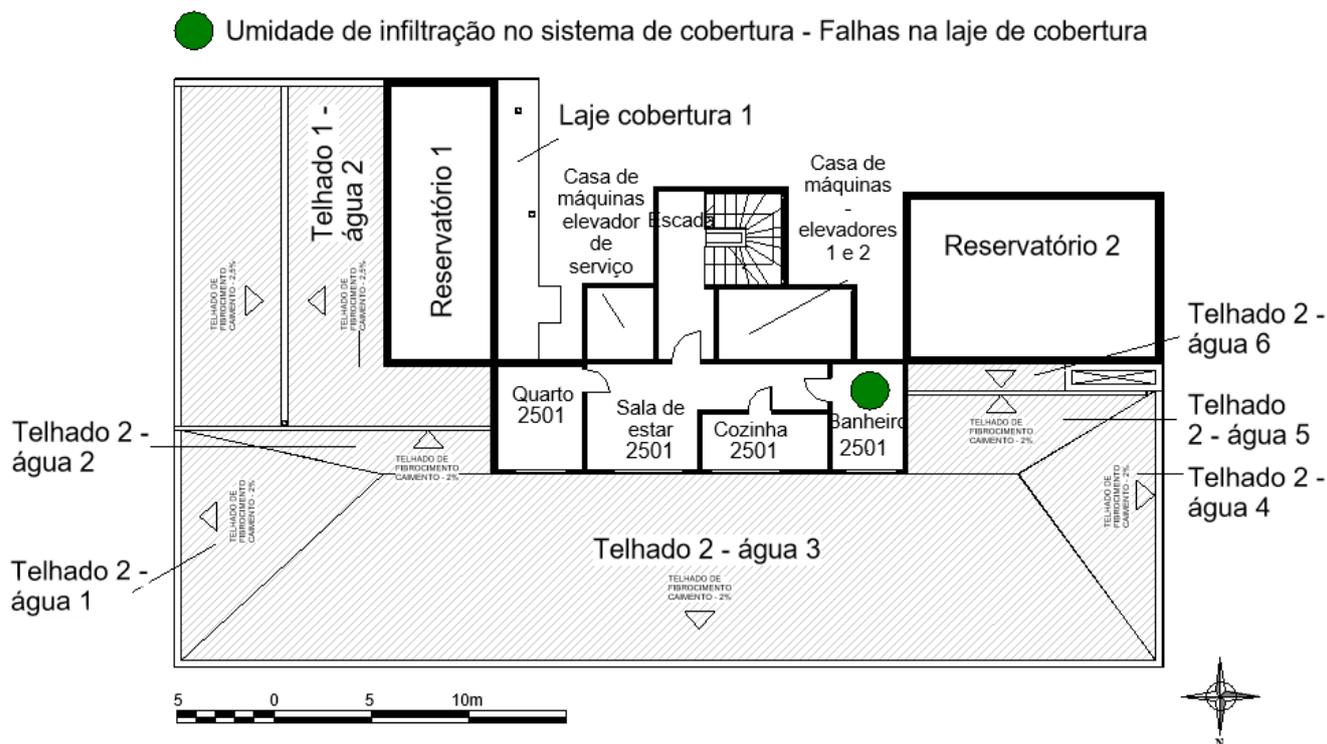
planta baixa do vigésimo quarto pavimento com representação das manifestações patológicas
